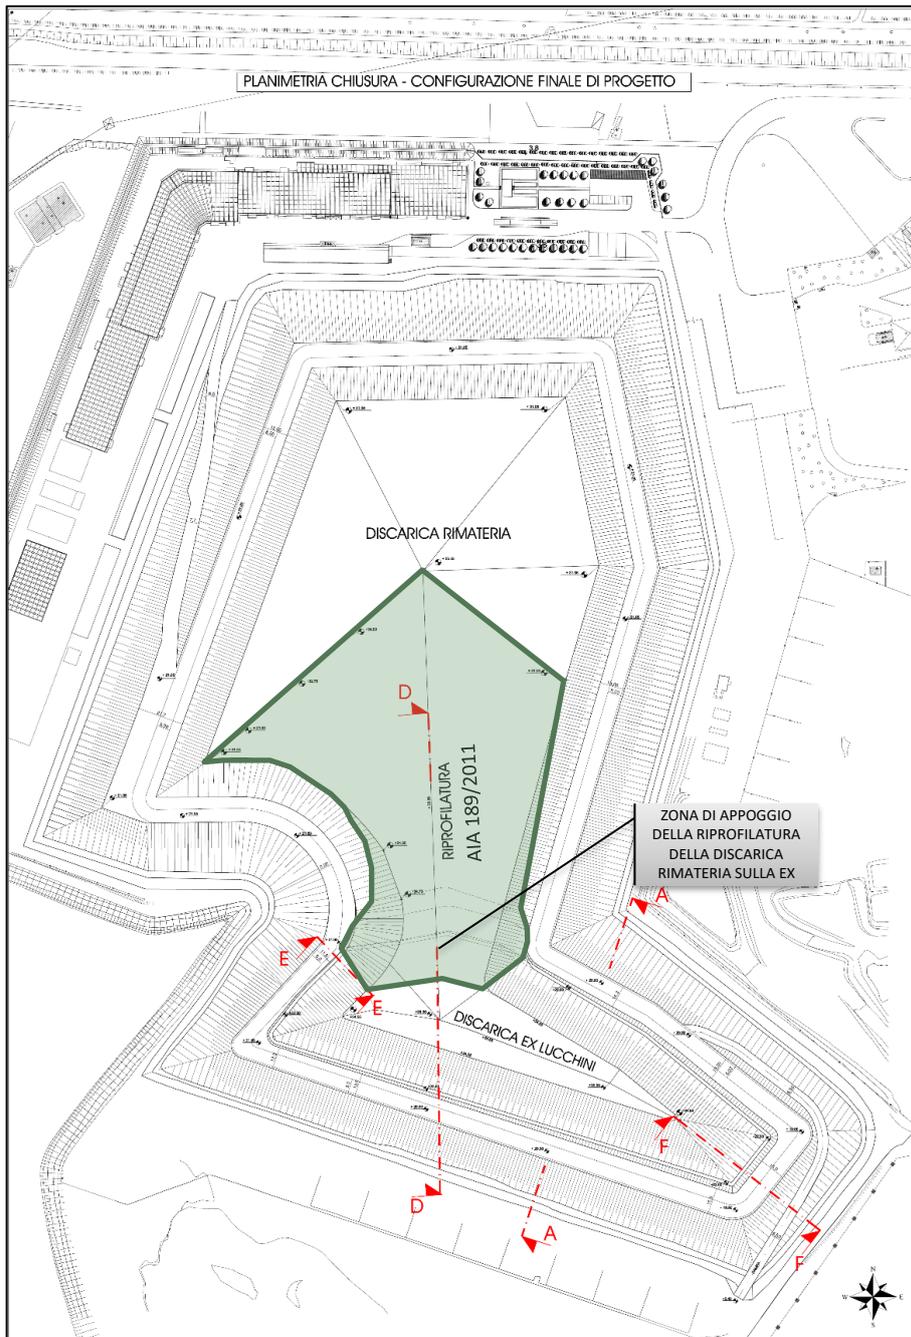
Planimetria configurazione finale di progetto con evidenziate riprofilatura discarica Rimateria (estratto dalla tavola di progetto TAV.2 VAR_CAP_TAV02_r2)
